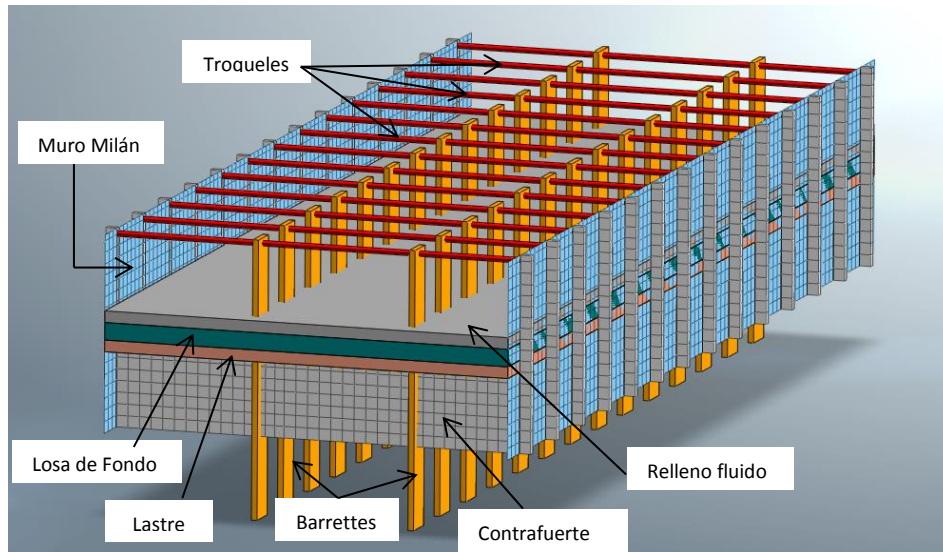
Arreglo tridimensional del Nivel Máximo de Excavación – Colocación de lastre, losa de fondo y relleno fluido.
